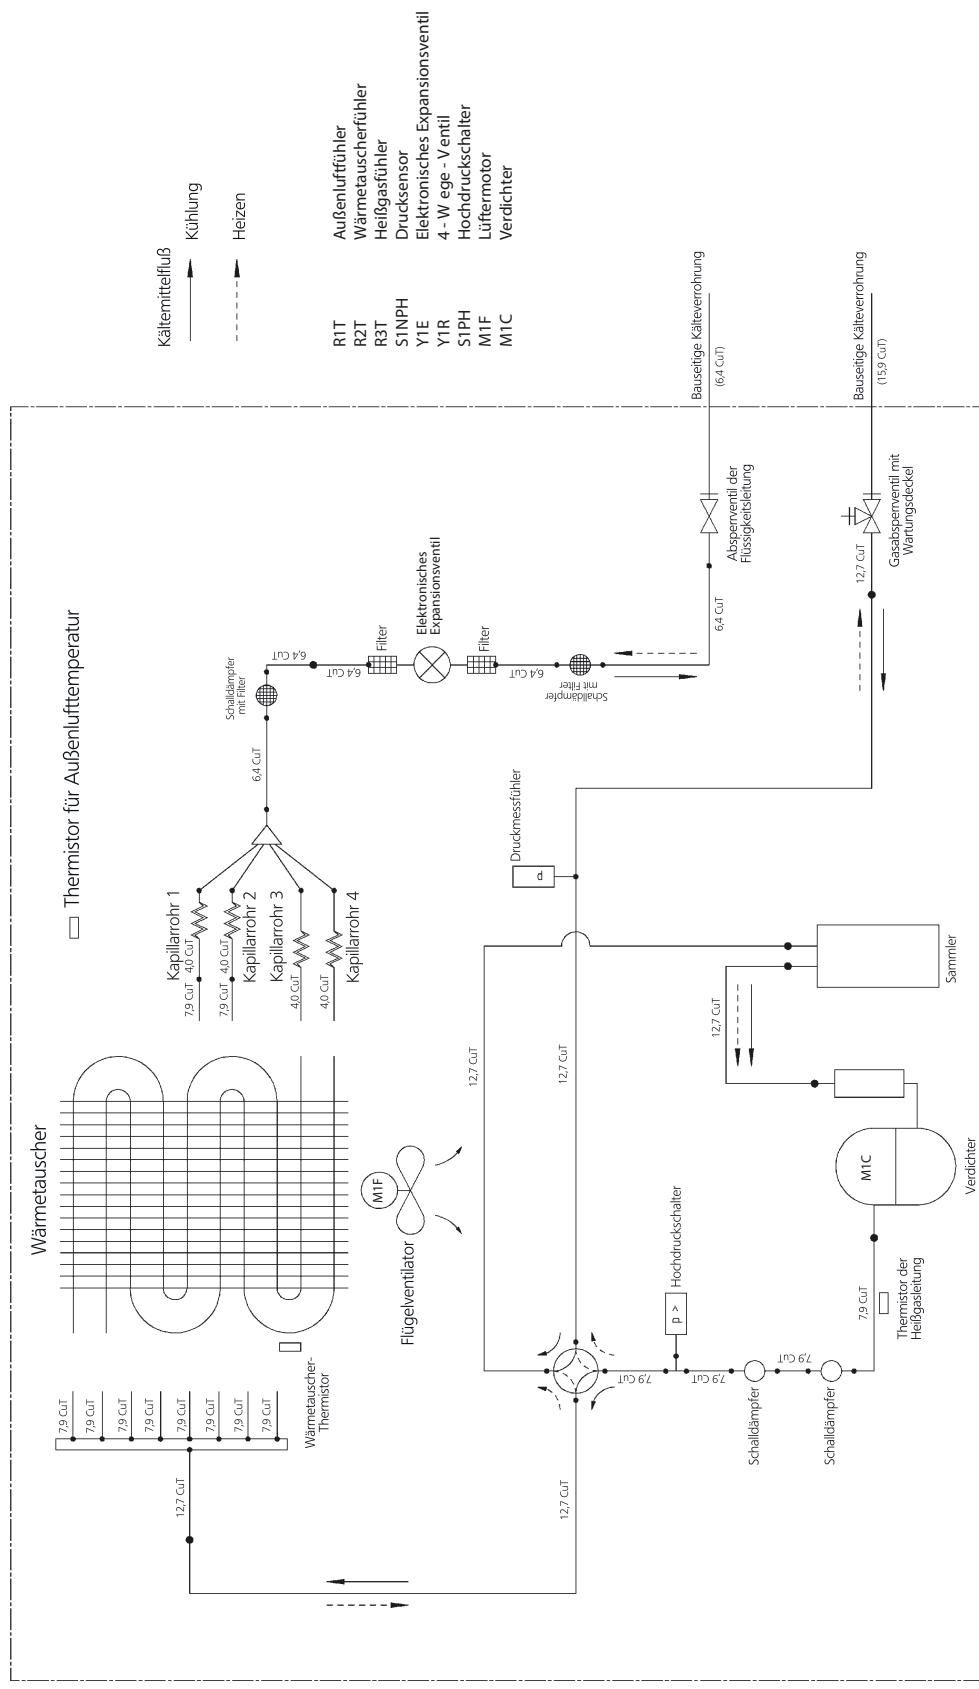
Kältetechnischer Aufbau - Außengerät RRLQ00(4/6/8)
